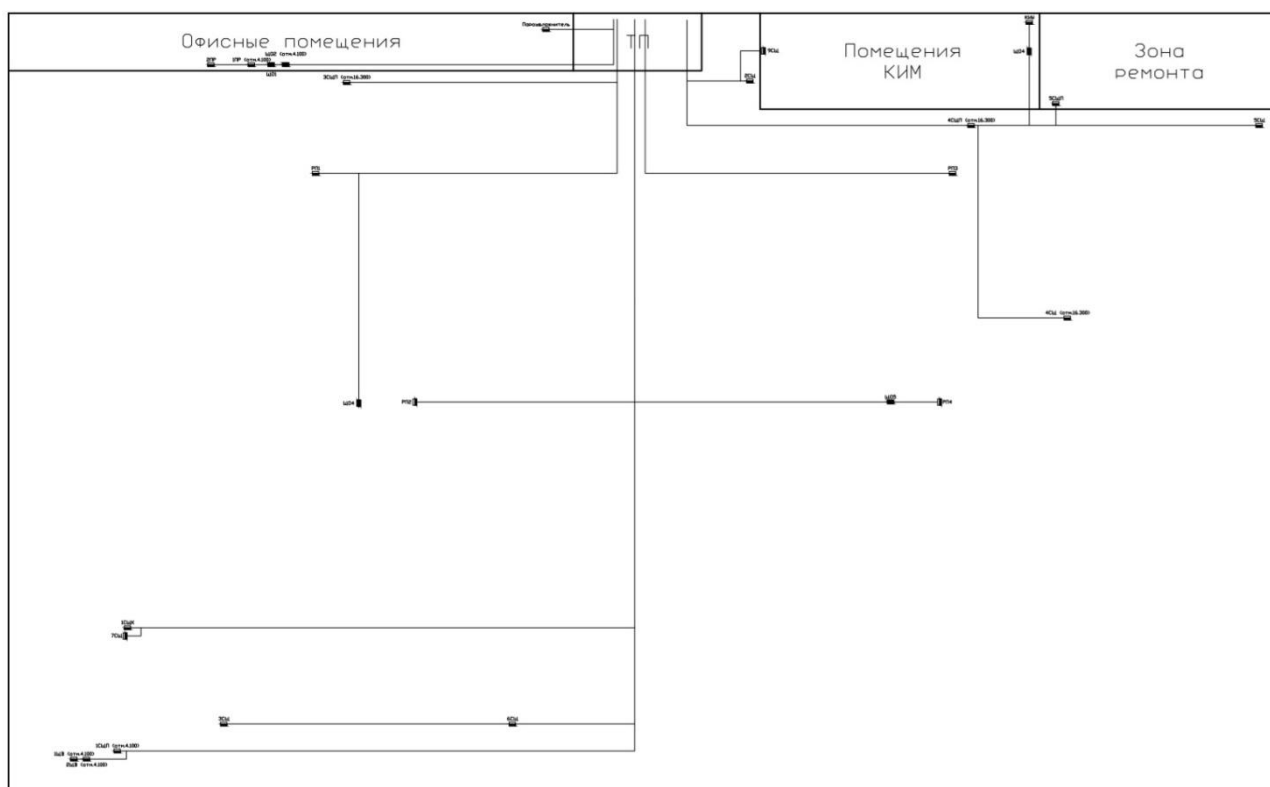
План размещения РП цеха сварки
